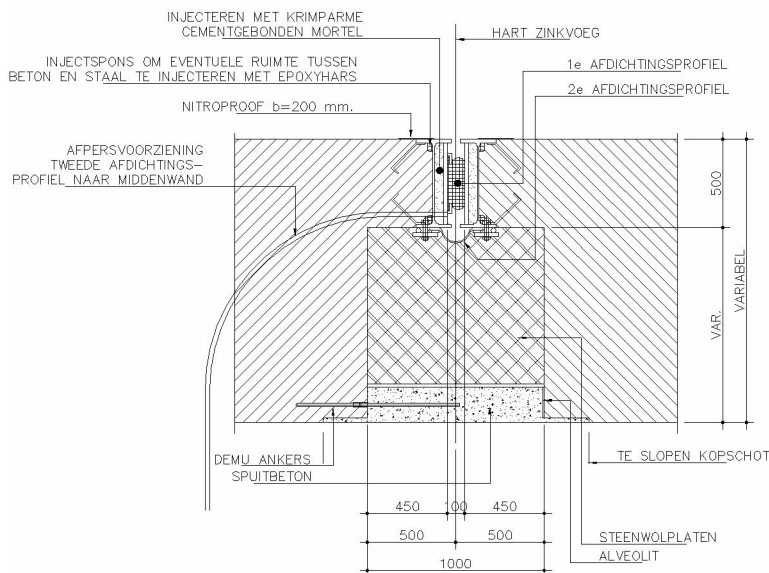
In te storten aanslag in het dak (5.2.9.10)
